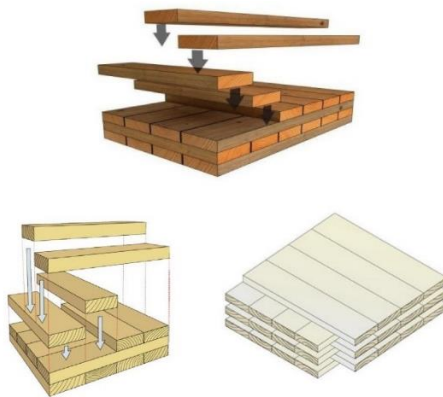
CLT (Cross Laminated Timber) [13]
